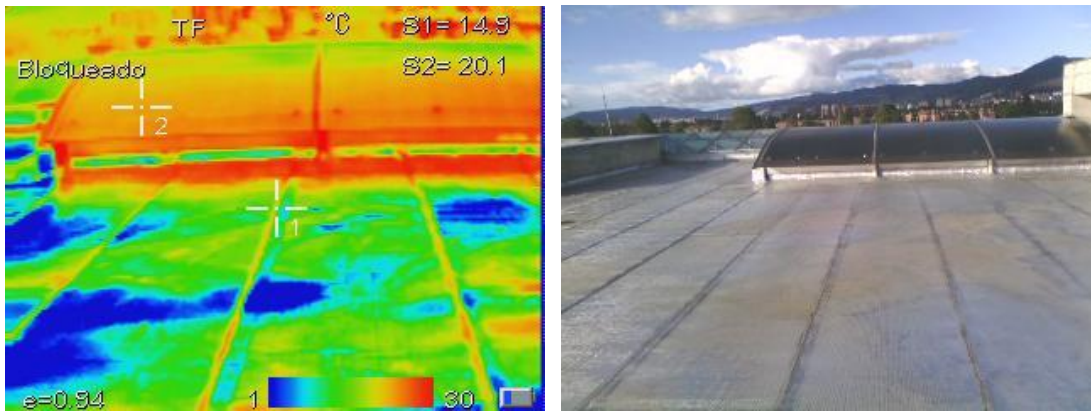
Termografías tomadas a las fachadas de mayor longitud y cubierta. Fuente:
